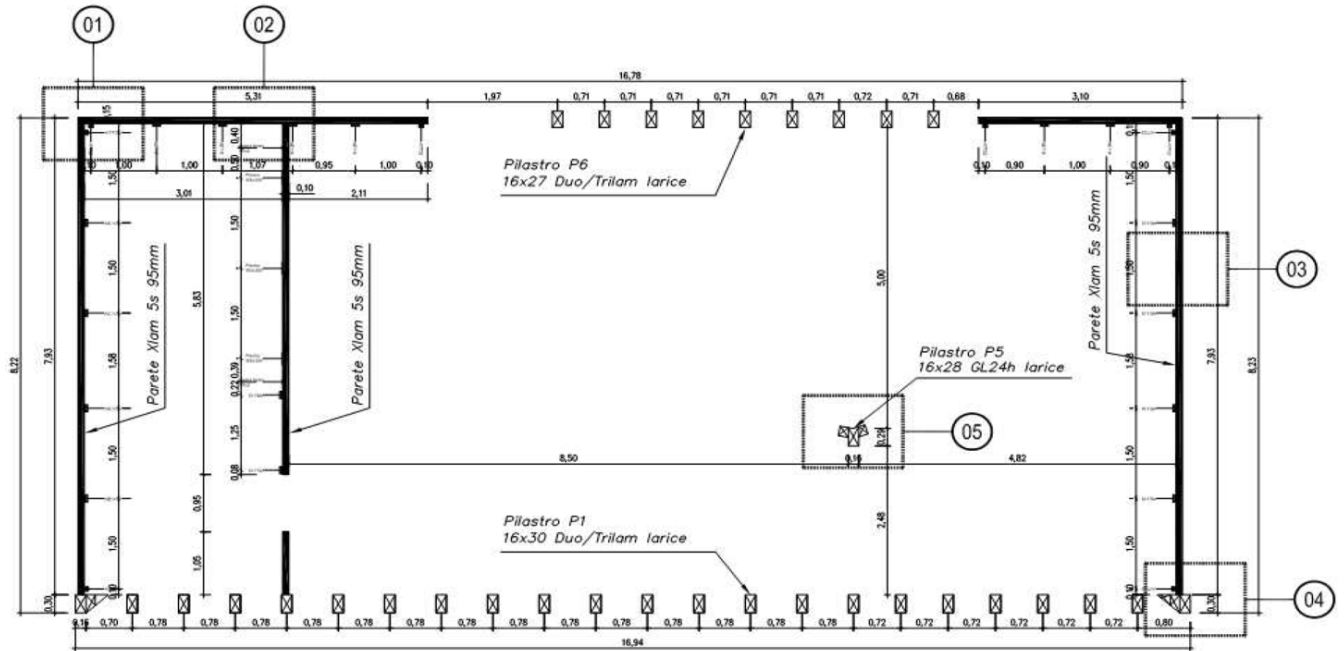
Pianta del piano primo (progetto fornito dal progettista Arch. Mirko Franzoso)
